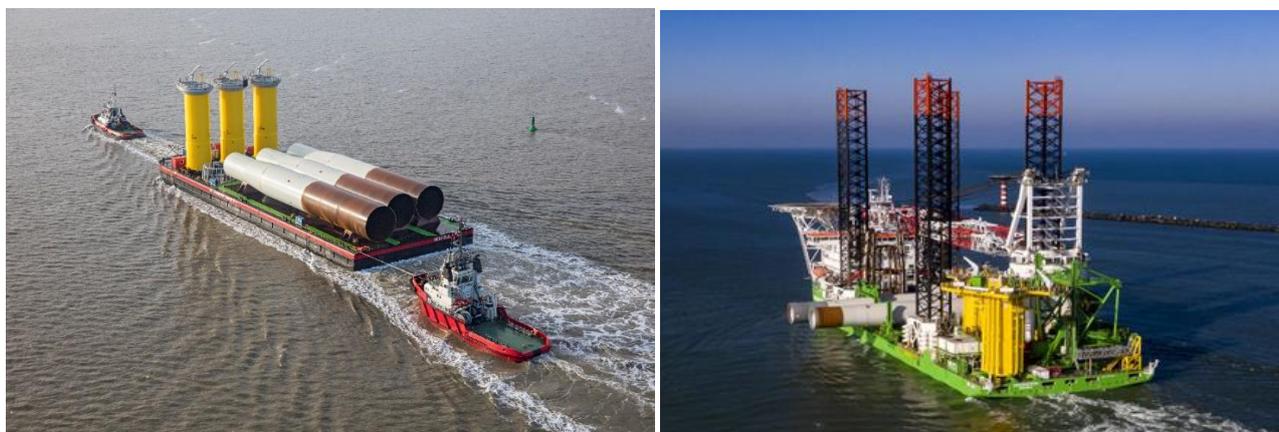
e 53: Trasporto di fondazioni monopalo ed elementi di transizione tramite chiatta (a sinistra) e tramite jack up con componenti fissati sul ponte della nave (a destra)
